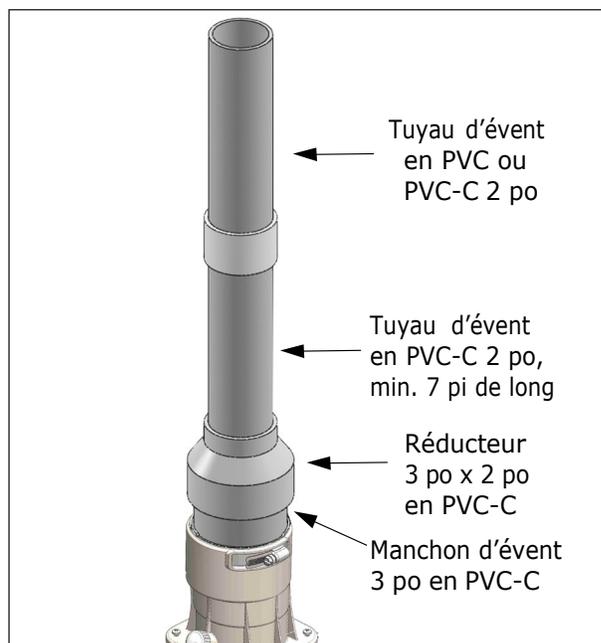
Installation verticale, système d'évent en PVC/PVC-C de 2 po (60 mm)
